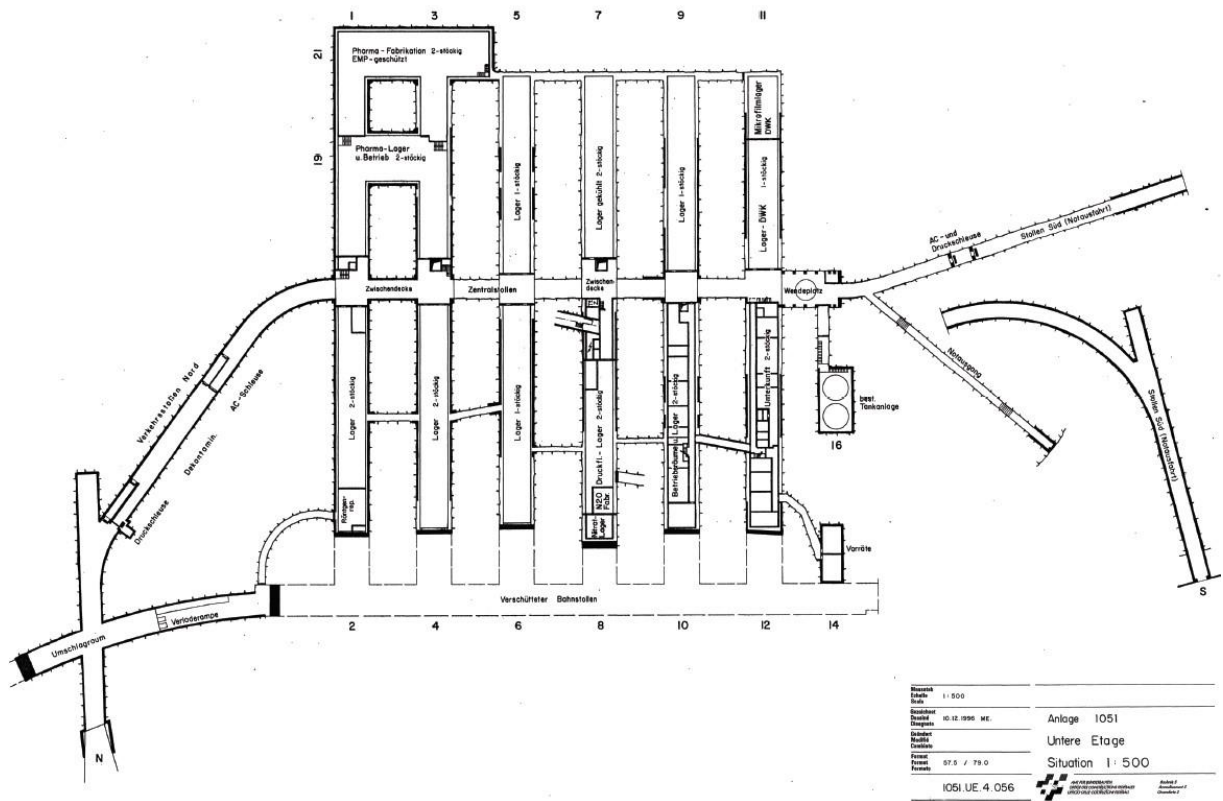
Grundriss ehemalige Munitionslager Mitholz (aktueller Stand).
